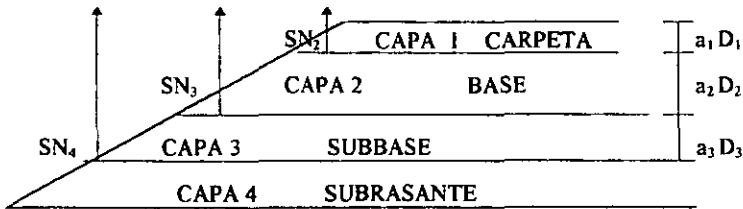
Dimensionamiento de la sección estructural de pavimento
